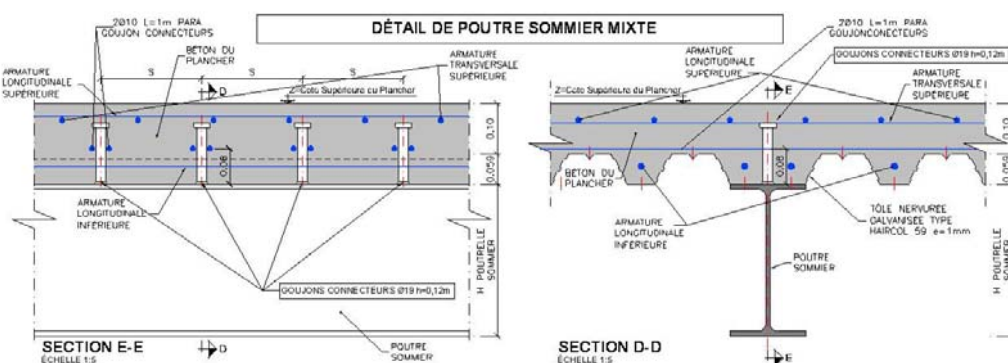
Esquema de forjados mixtos y detalle de viga principal mixta conectada al forjado.
